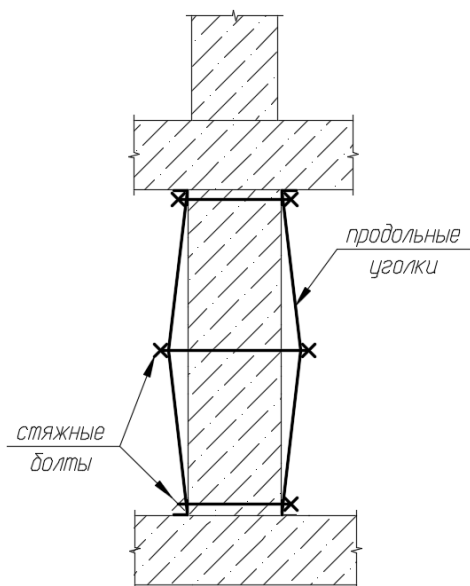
Усиление колонны предварительно напряжённой металлической обоймой
